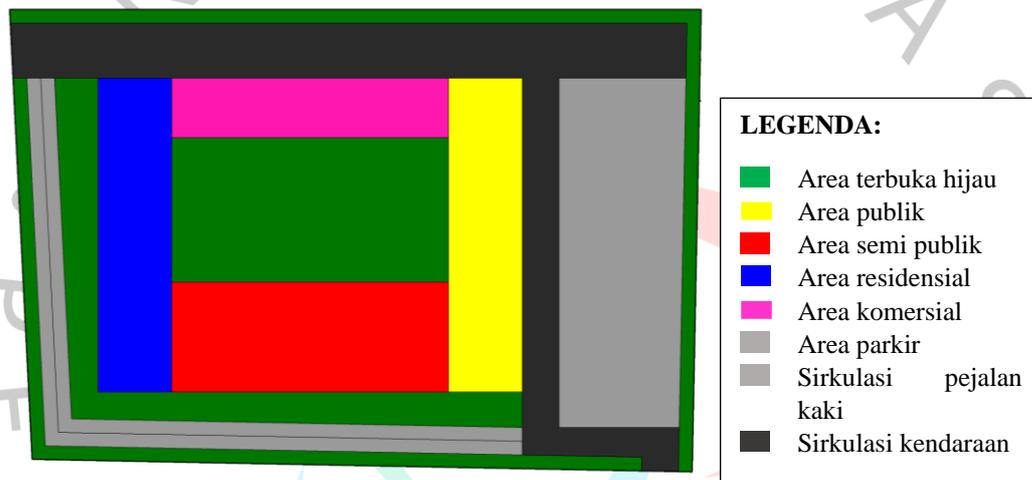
Gambar Rencana Zonasi Tapak.
